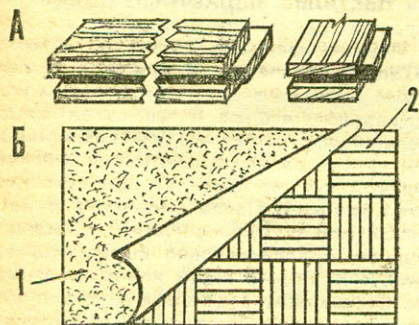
Виды паркета: А — штучная планка (клепка), Б — наборный щит: 1 — бумажный лист, 2 — клепка.
